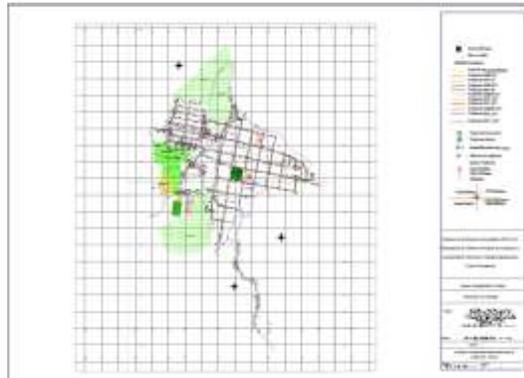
Plano Actualizado Sistema de Alcantarillado
